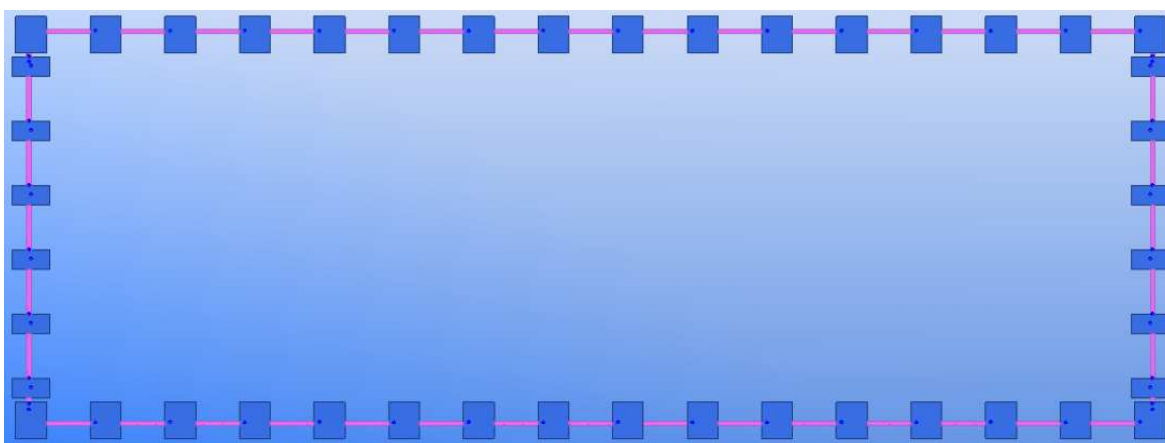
Cimentació de la nau vista en planta (Font: Tekla)
